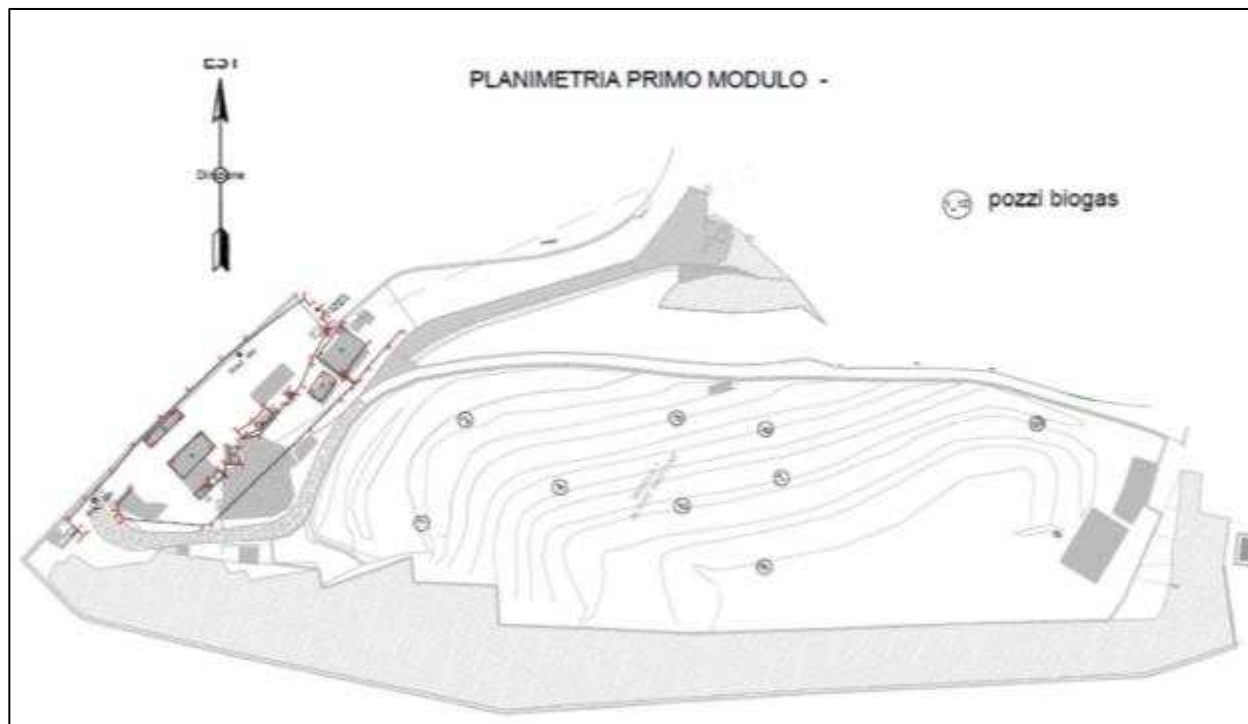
/V: Planimetria pozzetti di estrazione del biogas
